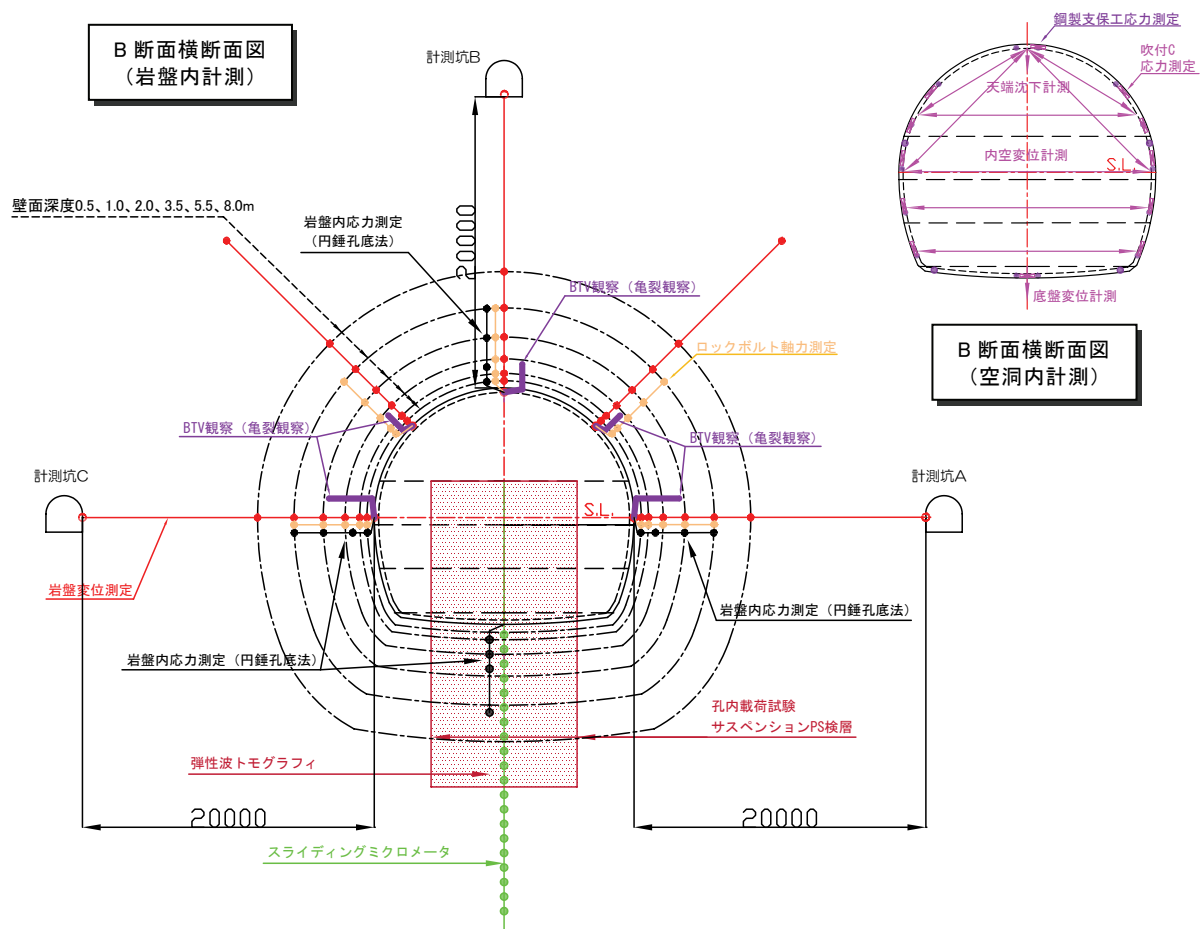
計測配置図（試験空洞横断面図：B断面）³⁾
